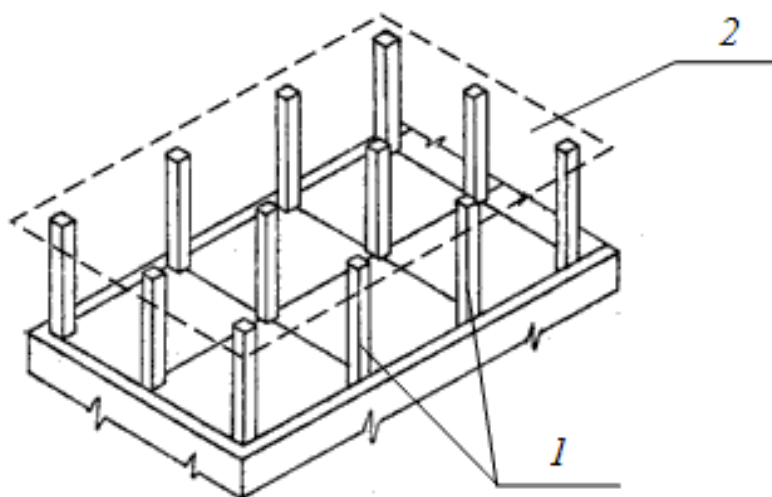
Конструктивная схема здания с безригельным каркасом:
